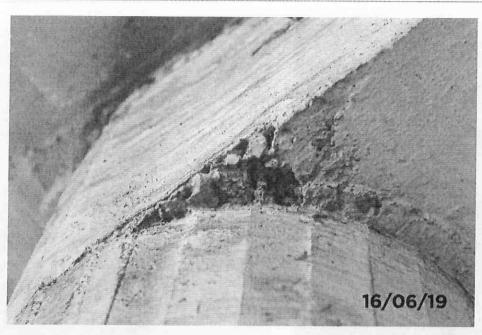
Detalhe do ponto isolado de destacamento do concreto no topo do pilar.
